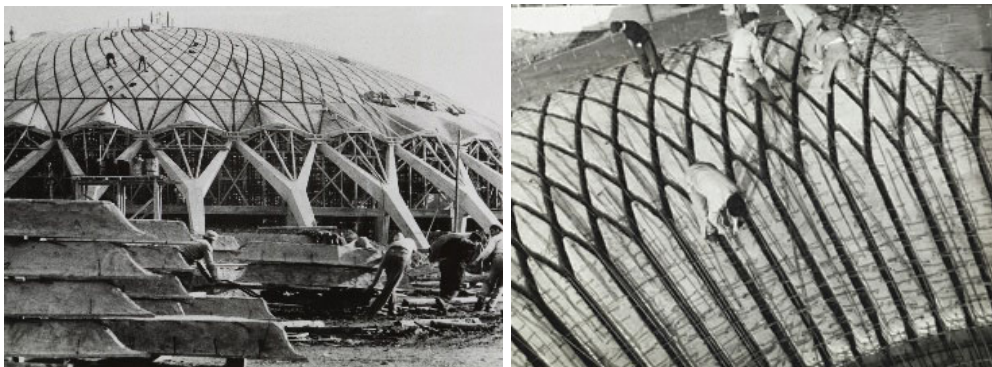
Ciclo construtivo pavilhão dos desportos, Roma, Itália, 1960 Pier Luigi Nervi
